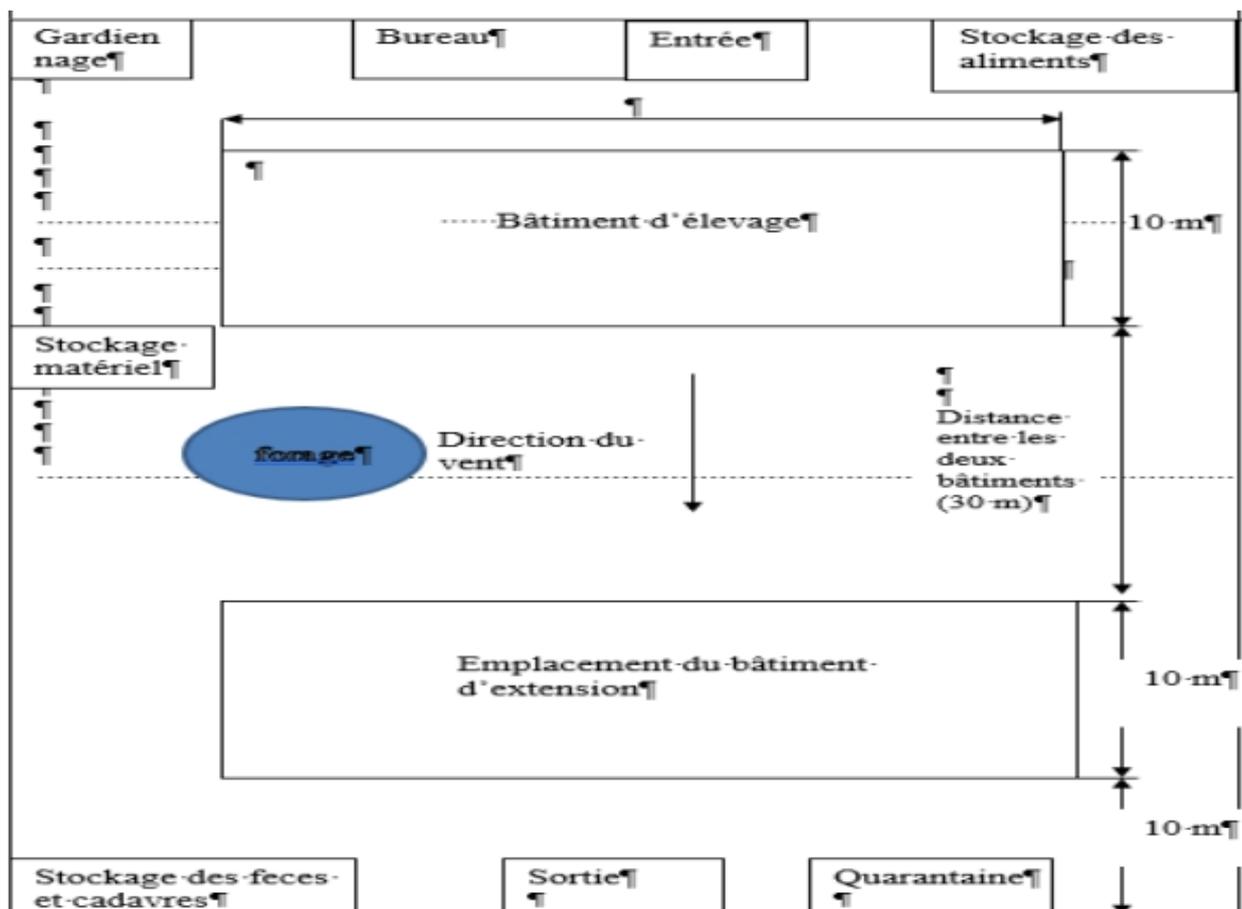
Plan d'une ferme avicole (Zoyium, 2021)
